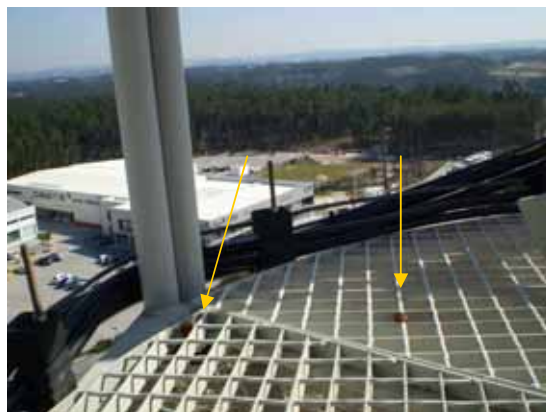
Aspecto de fixação de gradil em rede distendida a elemento soldado a anel de fixação.
